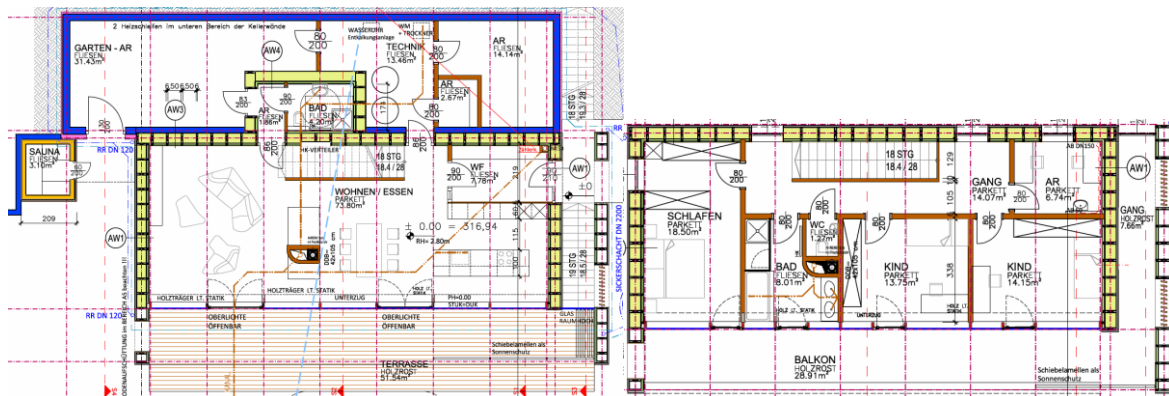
Grundriss EG (links) und Grundriss OG (rechts) des Solarhauses Tischler
